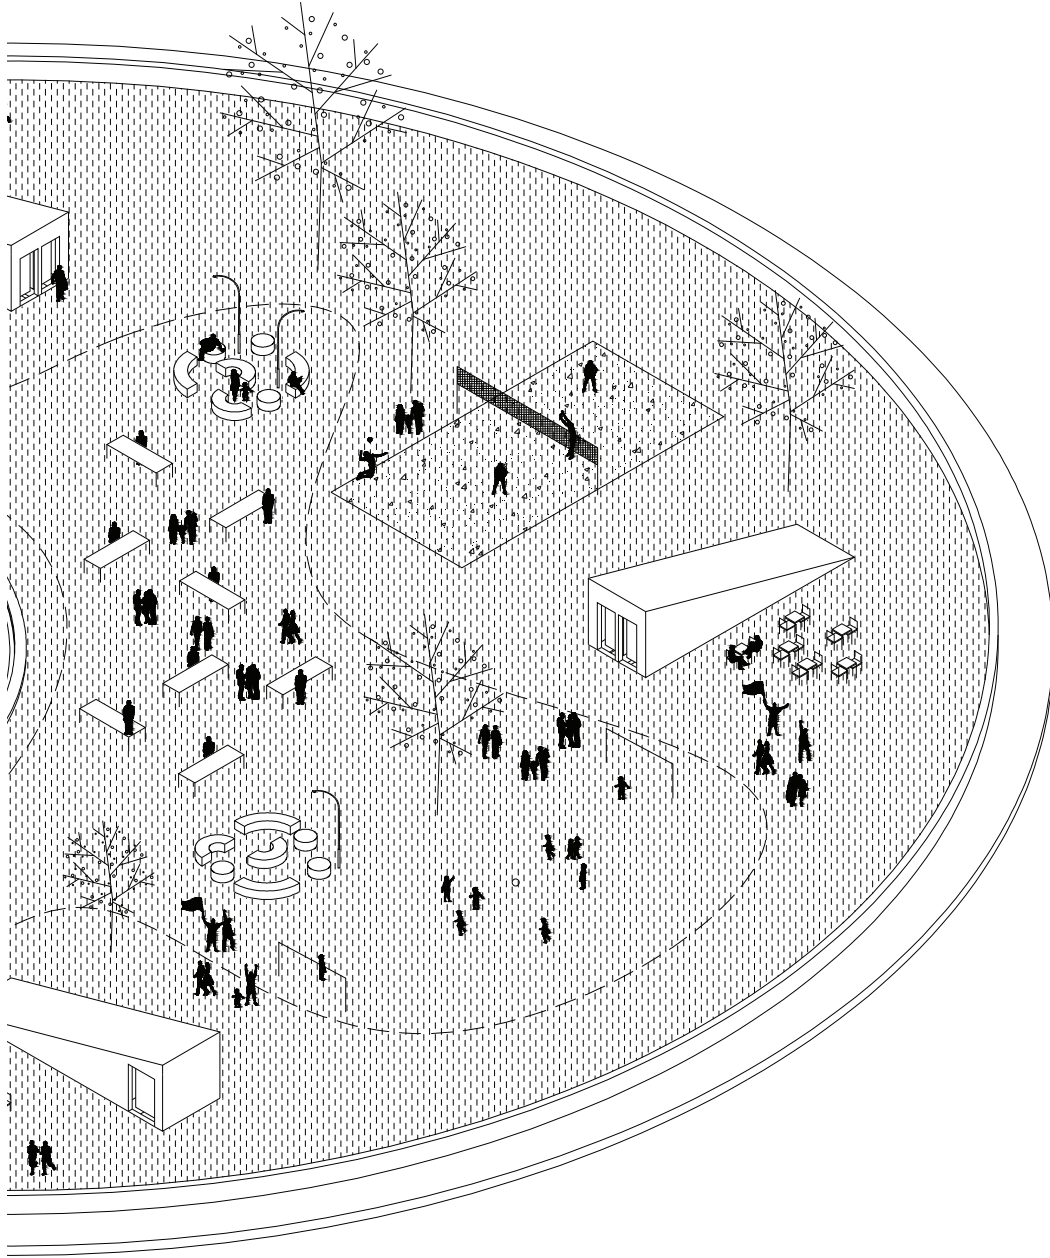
Grundrissaxonometrie . Dachlandschaft . 1:400
